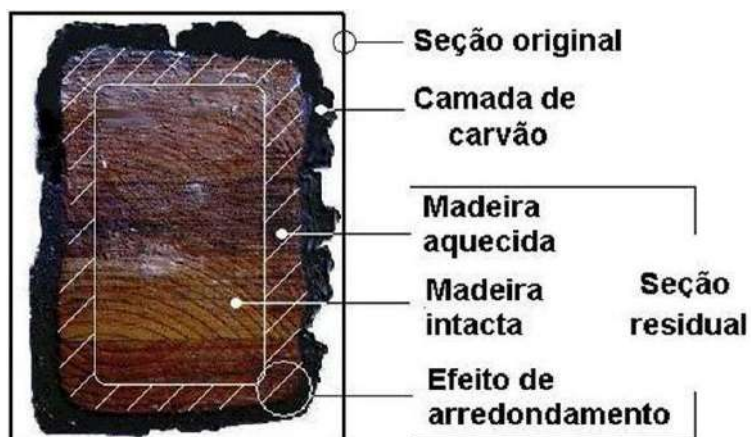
Seção de uma viga de madeira laminada colada, exposta ao fogo por 30 min (MADEIRA ESTRUTURAL, 2009).
